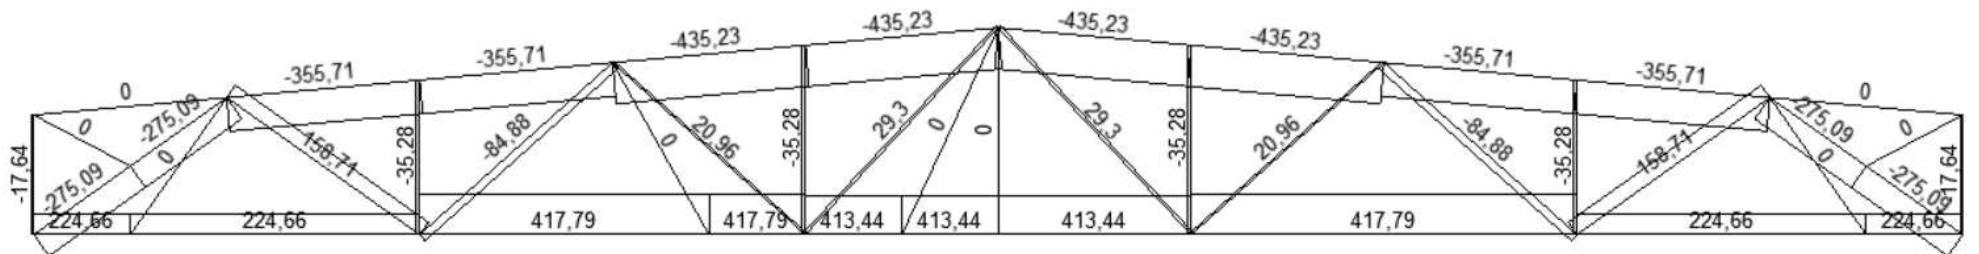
Эпюра внутренних усилий от снеговой нагрузки
